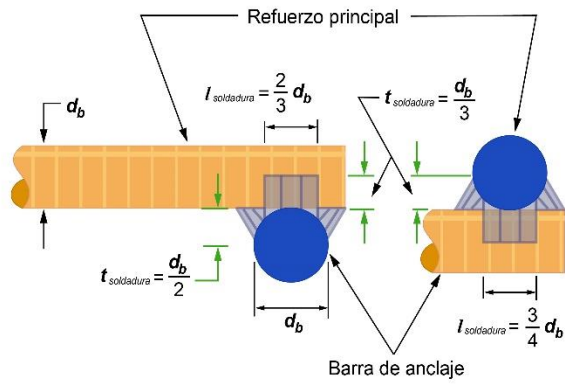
b – Detalle de la soldadura (adaptada de ACI CODE-318-19)
